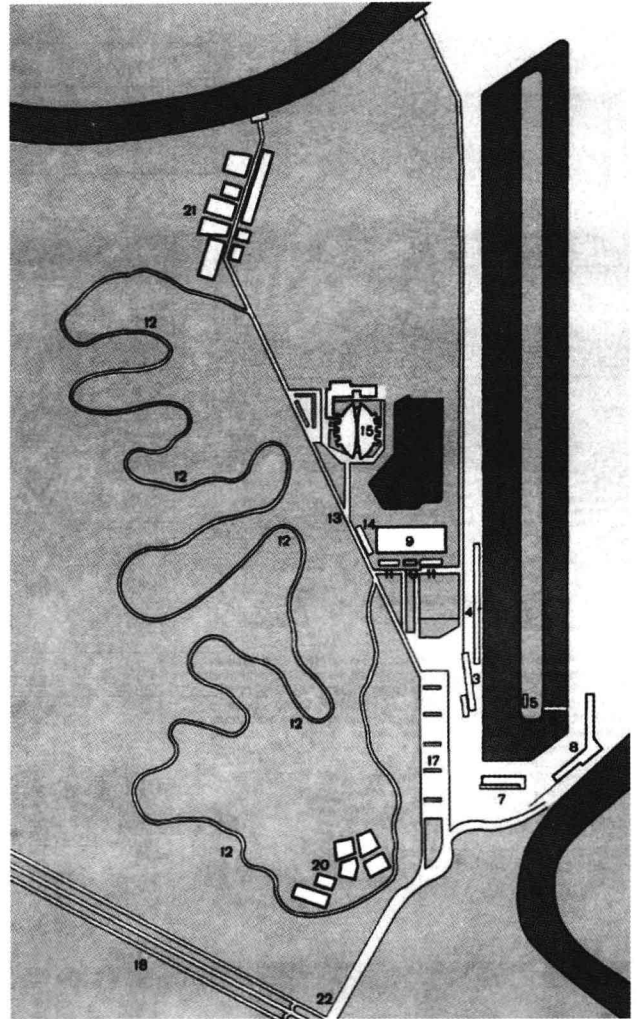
克里拉茨科耶 (Krylatskoye) 体育公园总平面图
